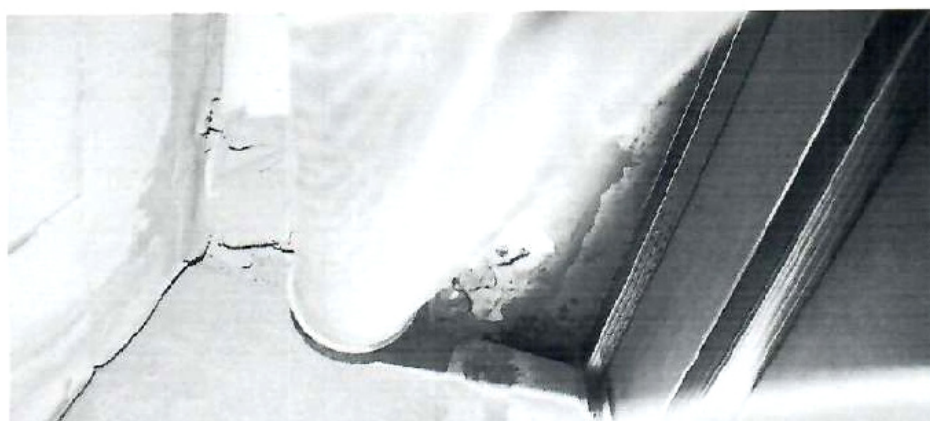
Незаполненный зазор между перегородкой и плитой перекрытия.
